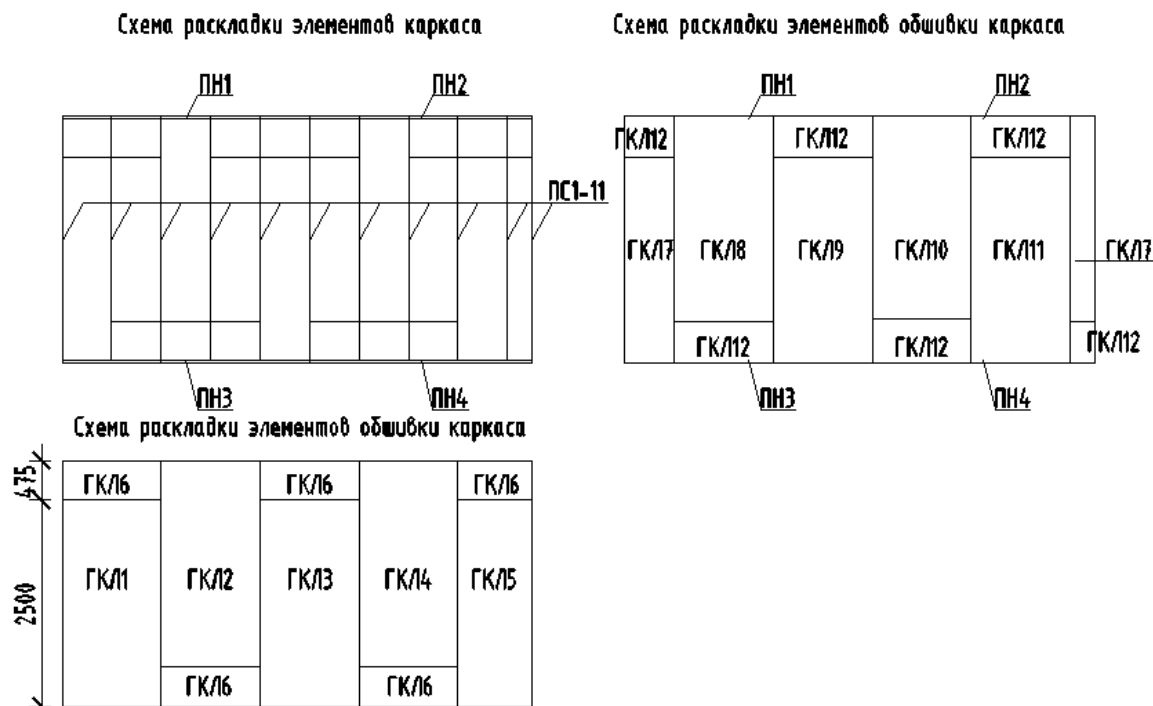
Эскизы каркасно-обшивной конструкции
